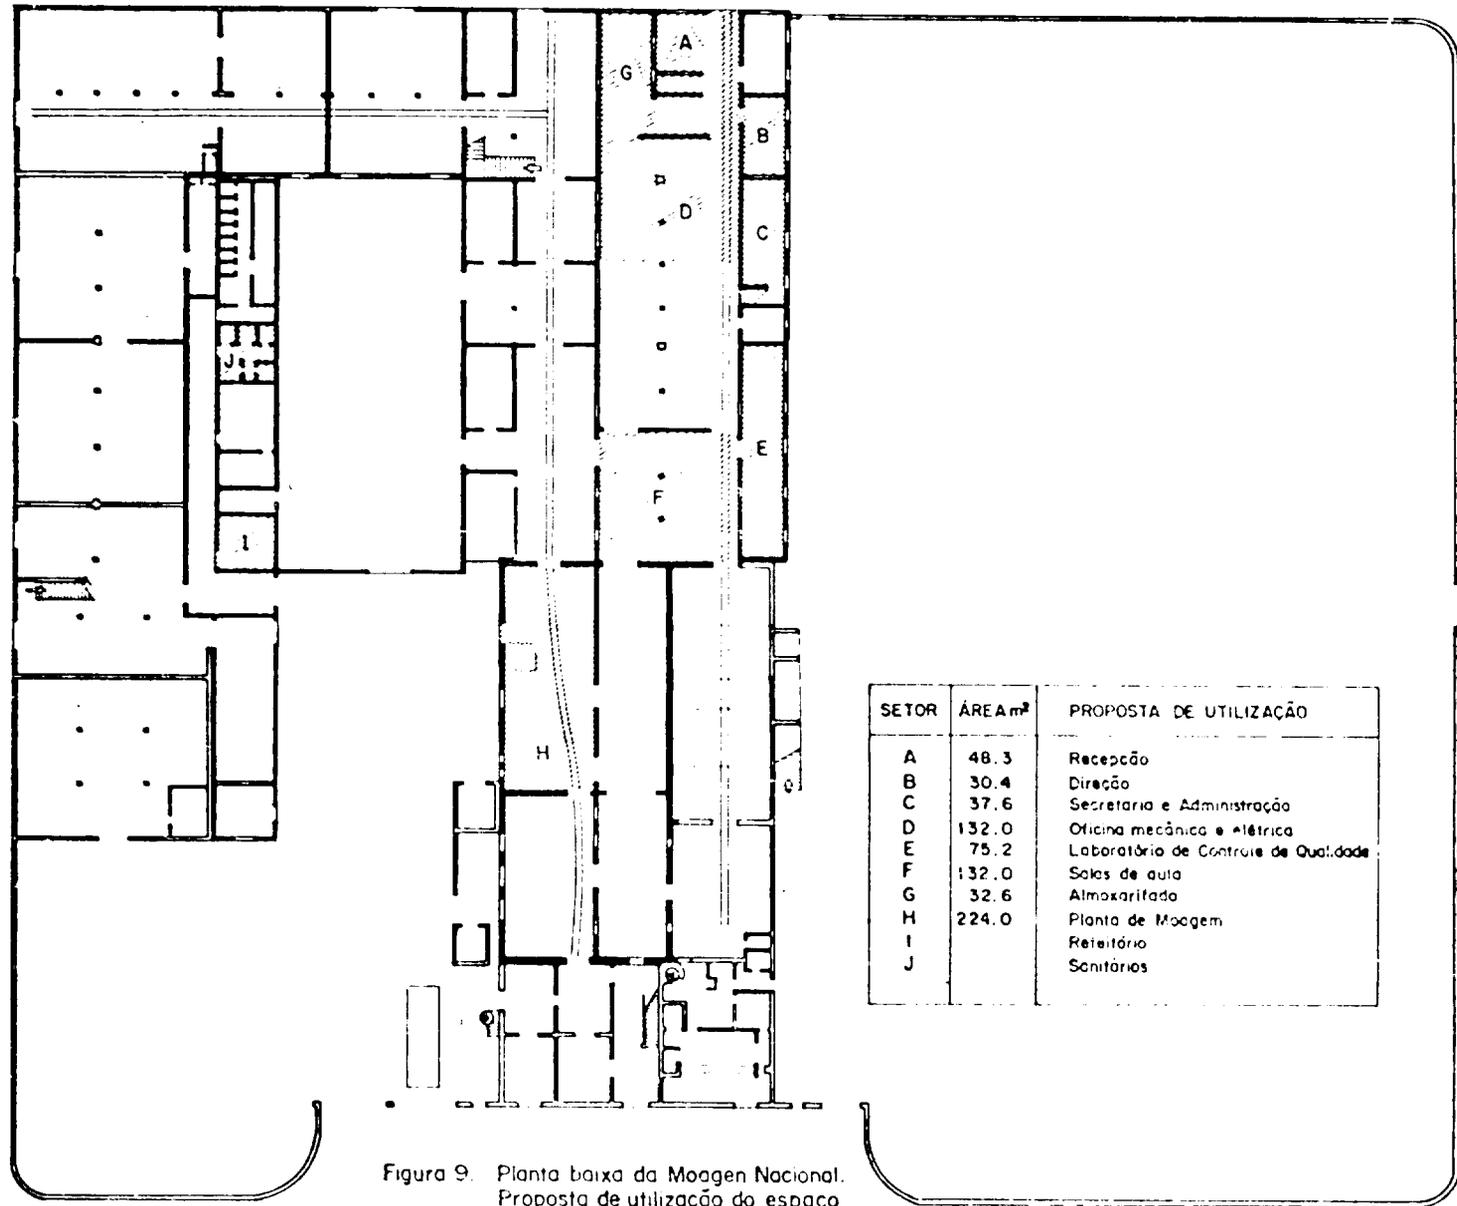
Planta baixa da Moogen Nacional. Proposta de utilização do espaço para o Centro Nacional de Treinamento.
